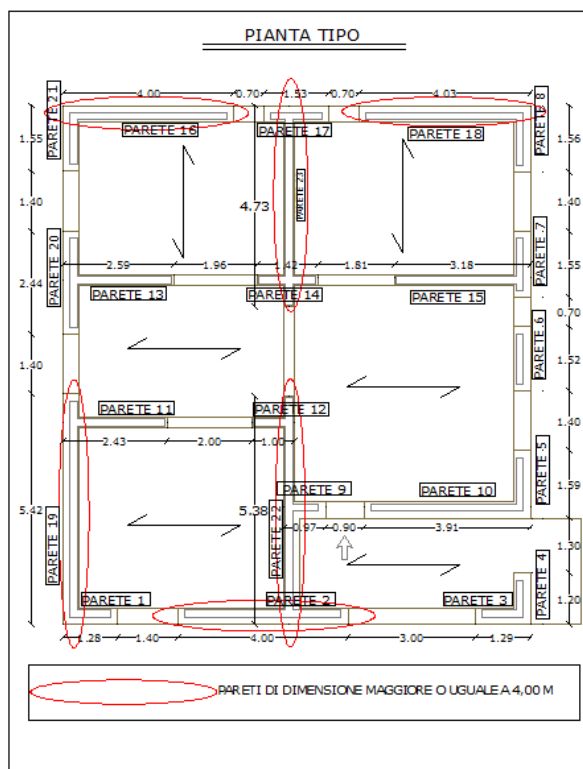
(pianta tipo per l'individuazione lunghezze delle pareti)
